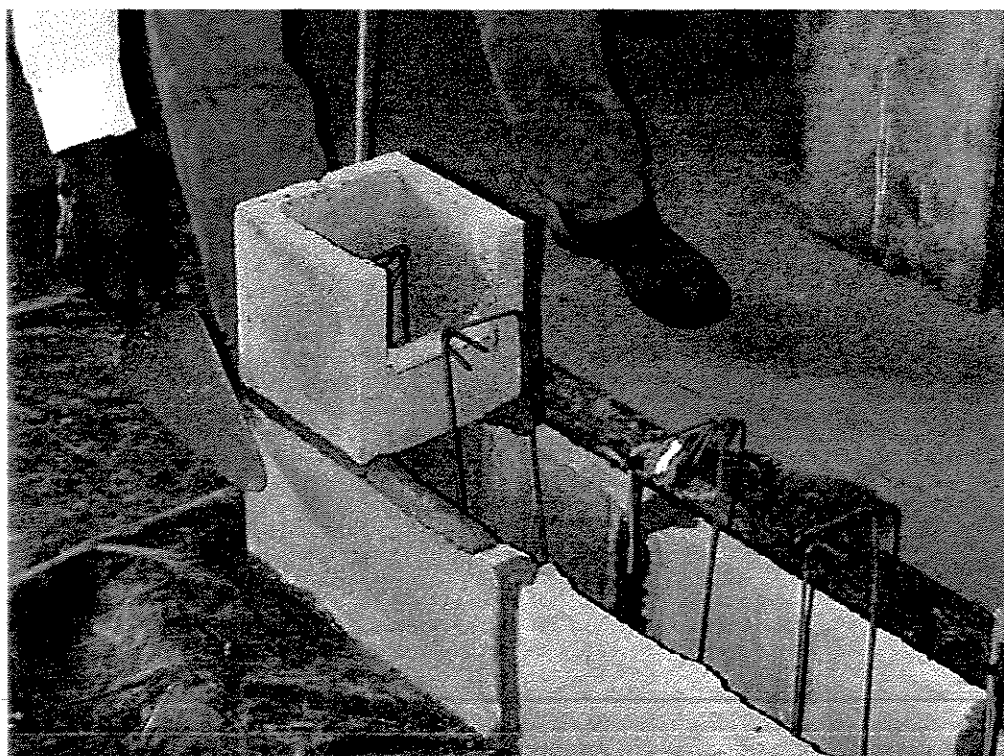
EXECUÇÃO DA SEGUNDA FIADA
